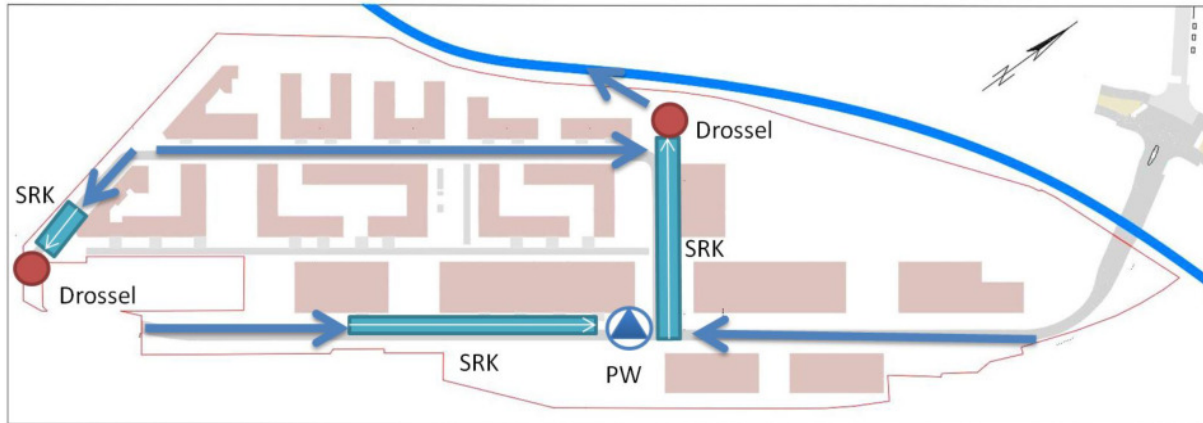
Regenwasserableitung Variante 3 – Pumpwerk in Planstraße C
